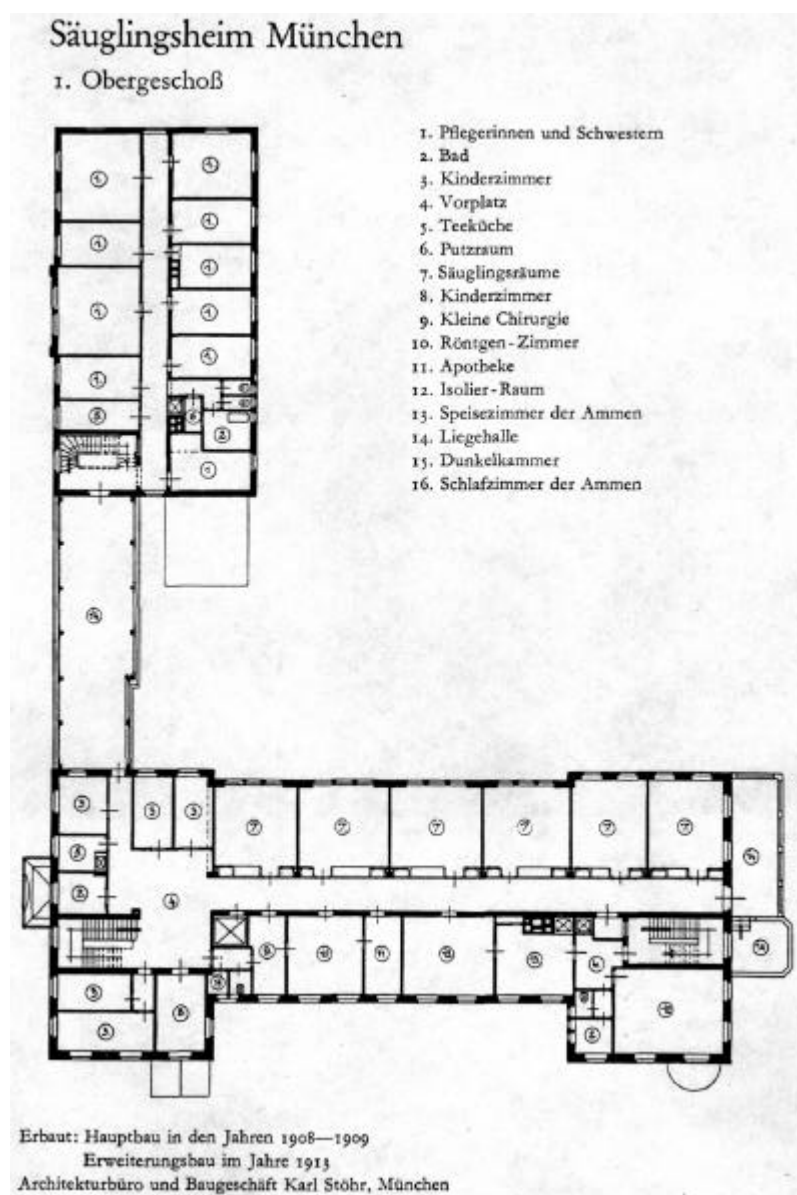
Grundriss 1. Obergeschoss (16,S. 26) mit Erweiterungsbau aus dem Jahre 1913
